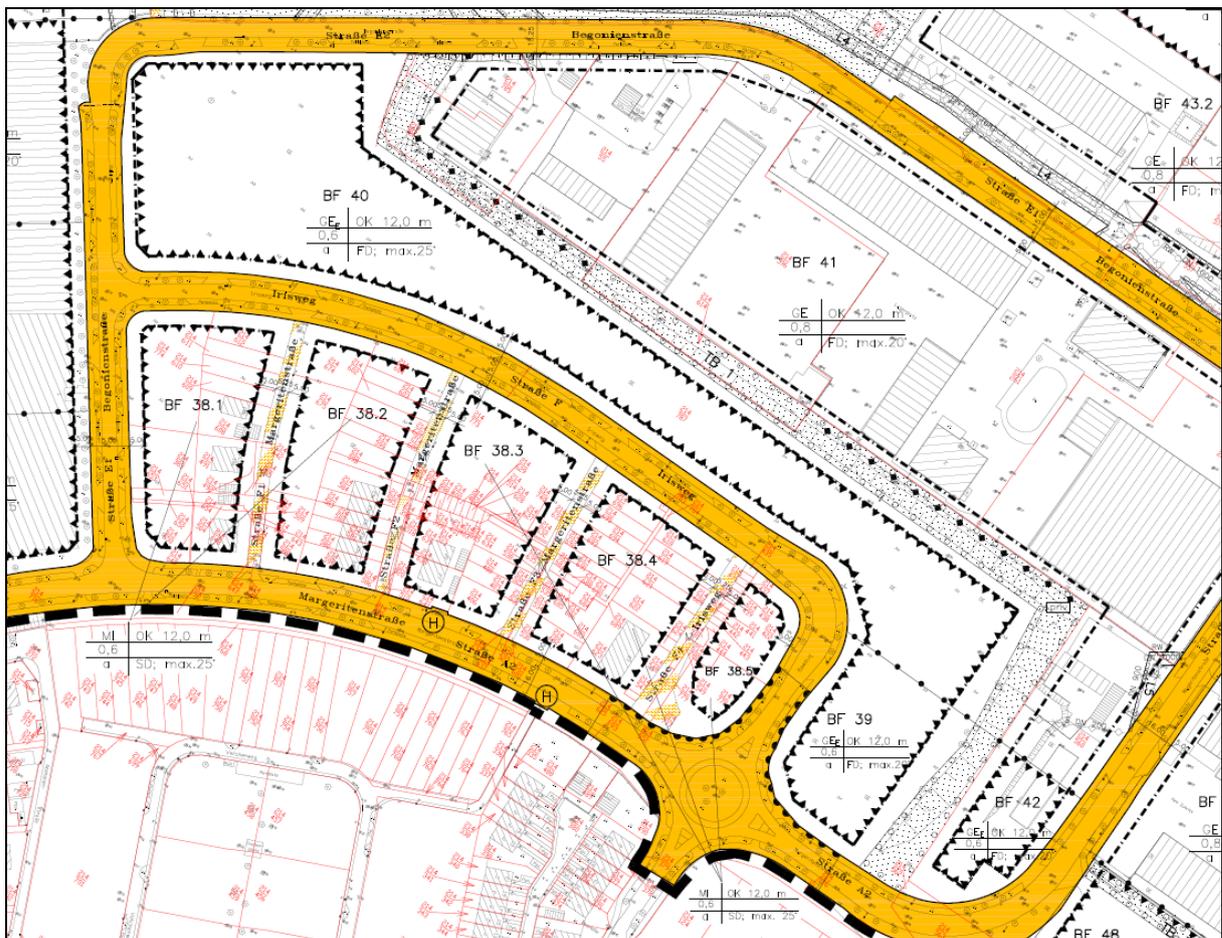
Ausschnitt aus dem gültigen Bebauungsplan
